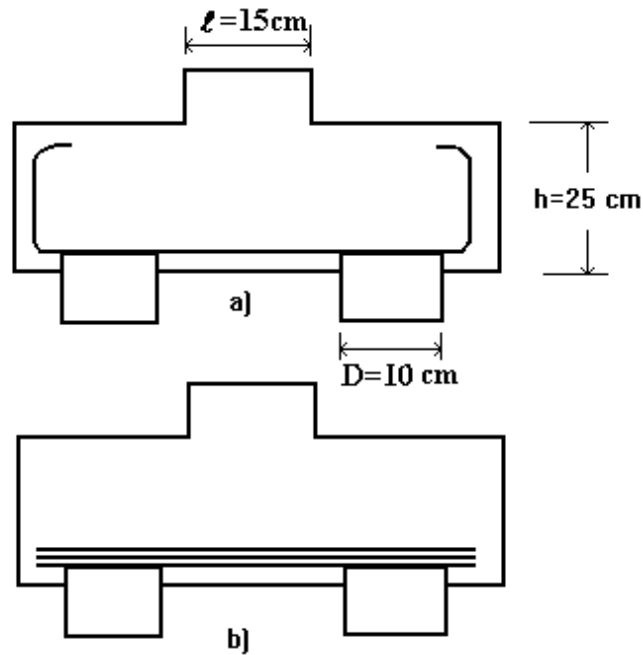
Disposições das armaduras (MAUTONI, 1972)
